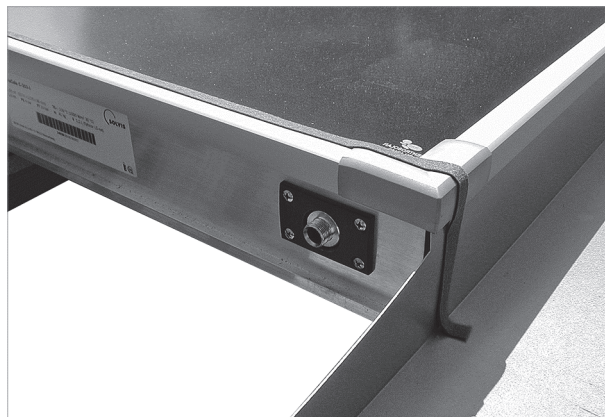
Collage d'une bande d'étanchéification sur toute la largeur de la bordure supérieure
